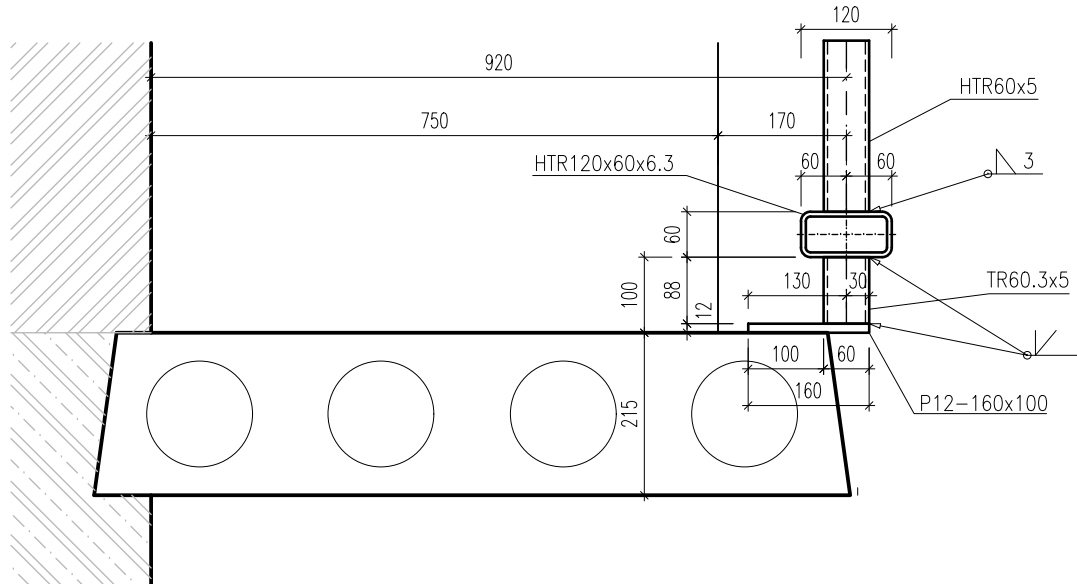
DETAIL B - DETAIL SPODNÍHO KOTVENÍ M 1:10
